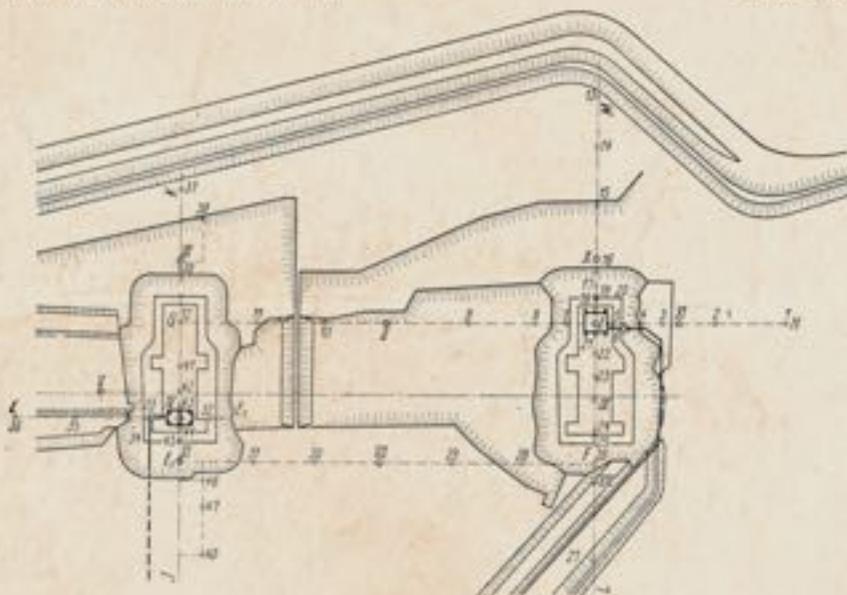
Plan de situation des installations d'essai de rabattement.
